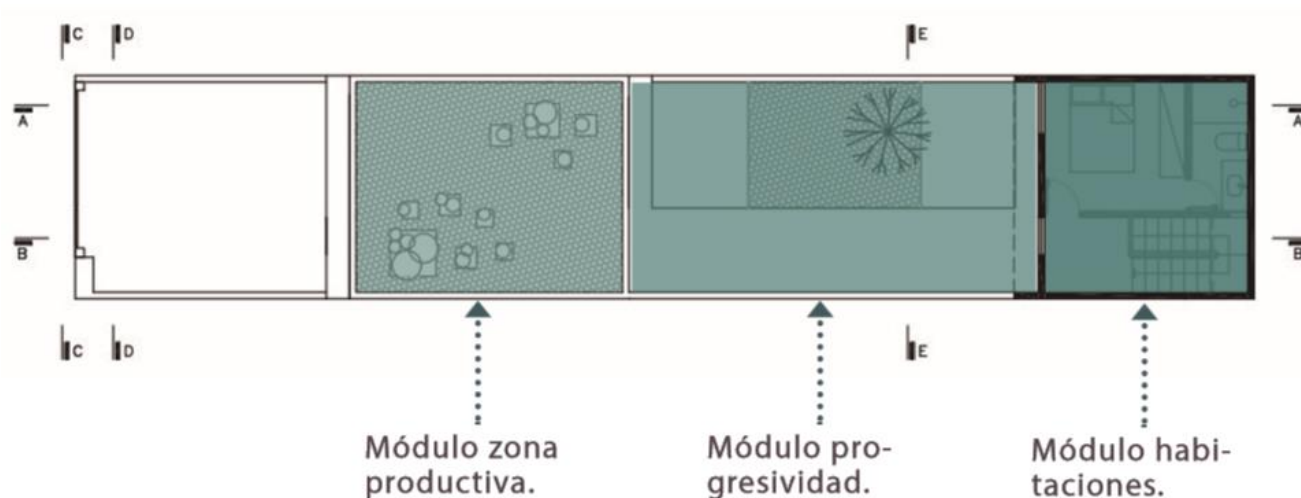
PLANTA SEGUNDO PISO VIVIENDA VILA MATILDE EN SAO PAULO, BRASIL.
